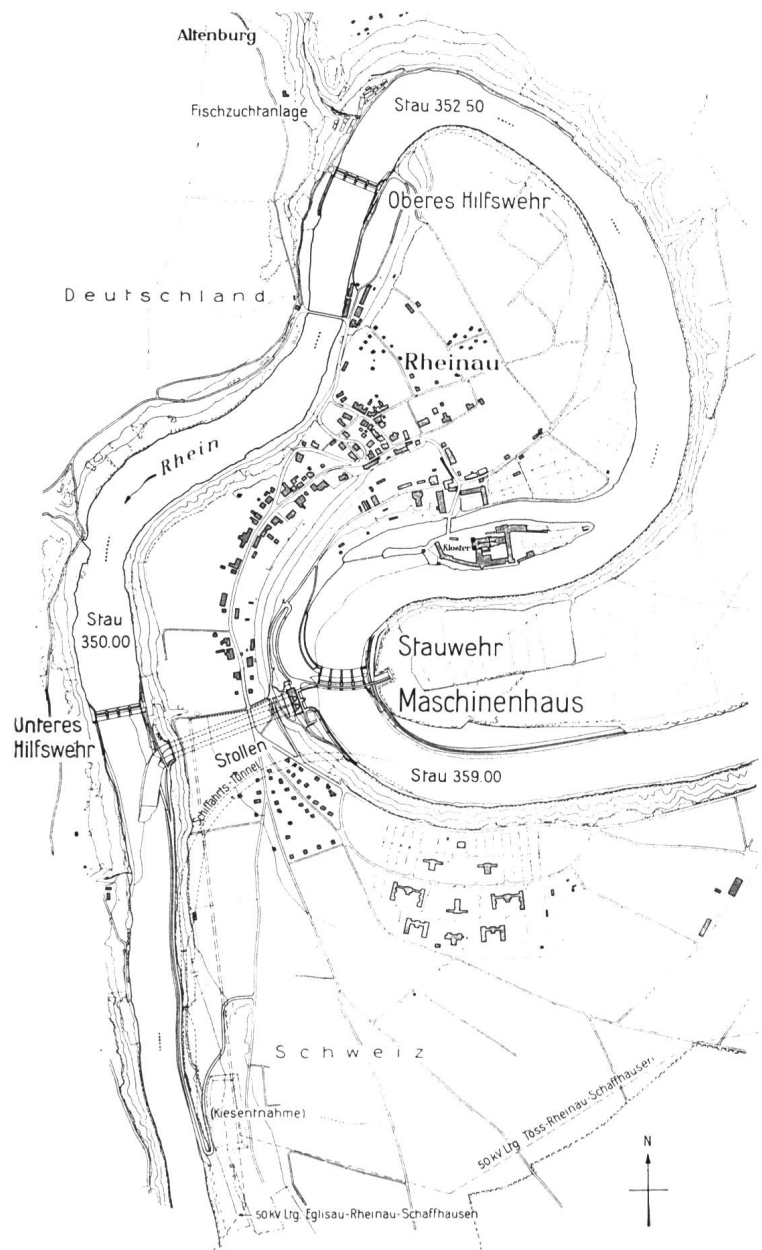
Rheinschleife mit Kraftwerkanlagen und projektiertem Schiffahrtstunnel, Lageplan 1 : 20 000
